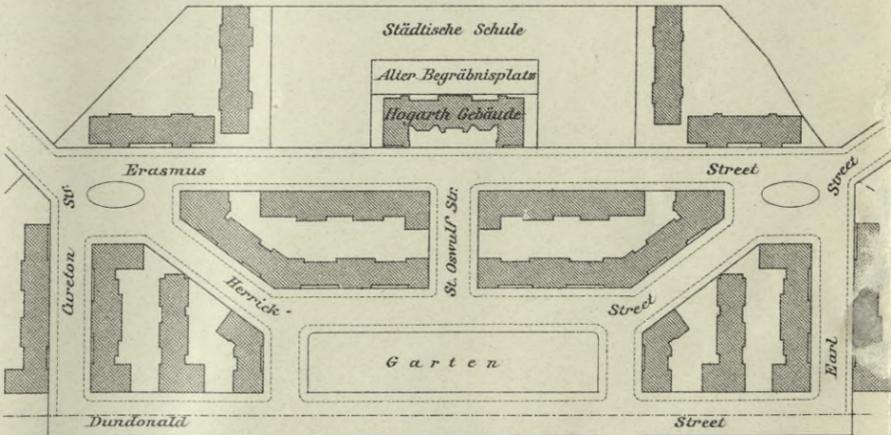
Bebauungsplan des Millbank-Grundstückes in London.
